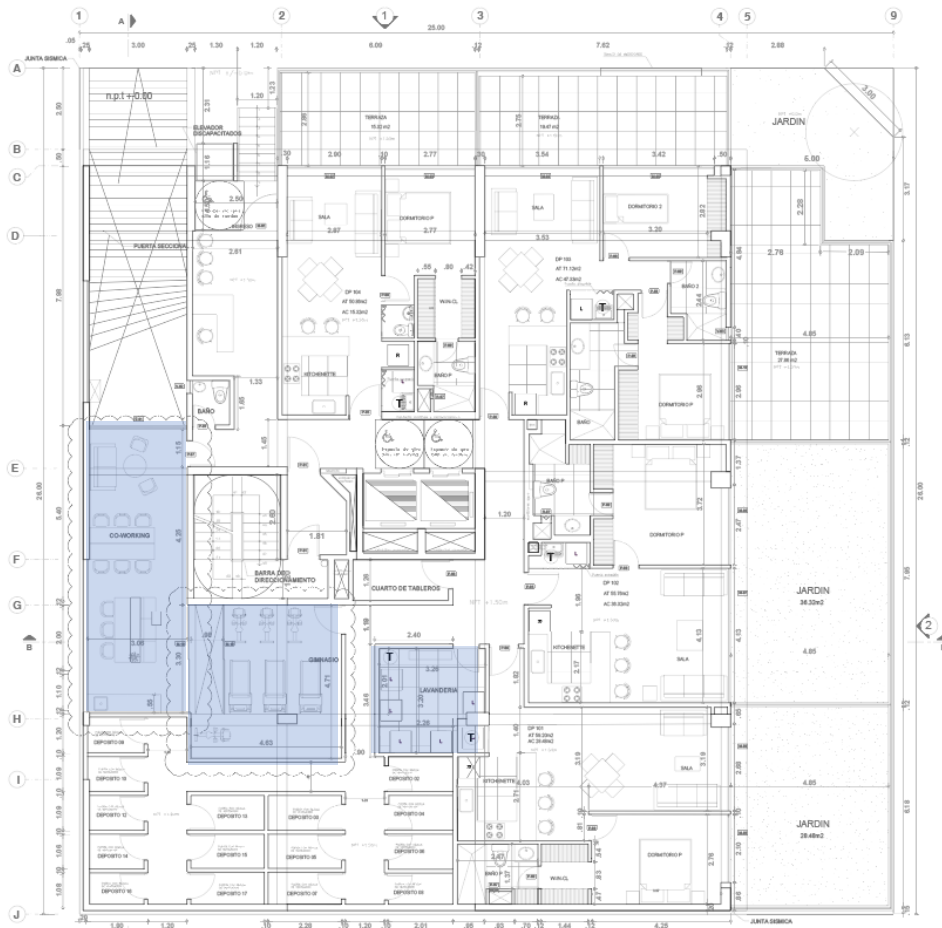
Planta baja proyecto QIU. Fuente: Plano editado de EE inmobiliaria
